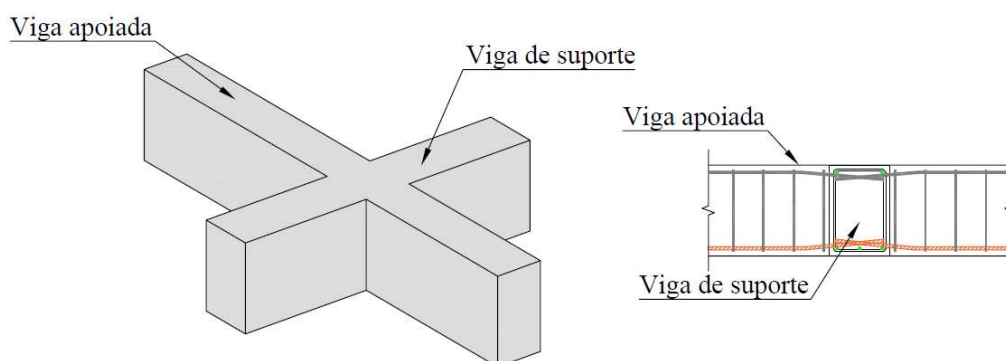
Disposição da armadura longitudinal para viga apoiada que se encerra na viga de suporte
